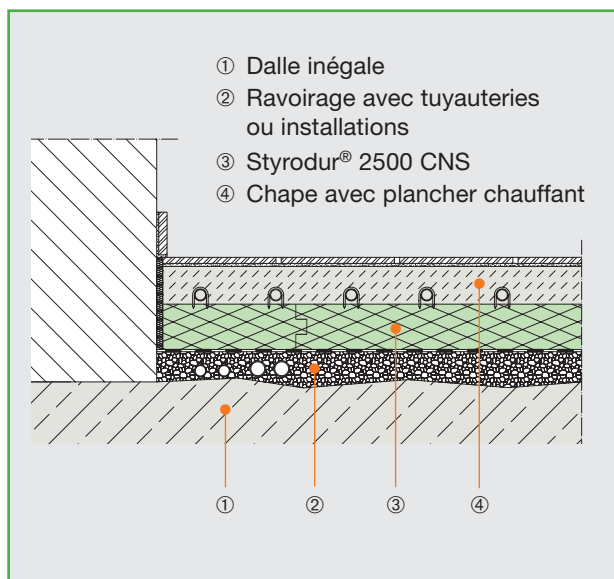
Plan en coupe d'un sol avec Styrodur 2500 CNS et avec un ravaillage
